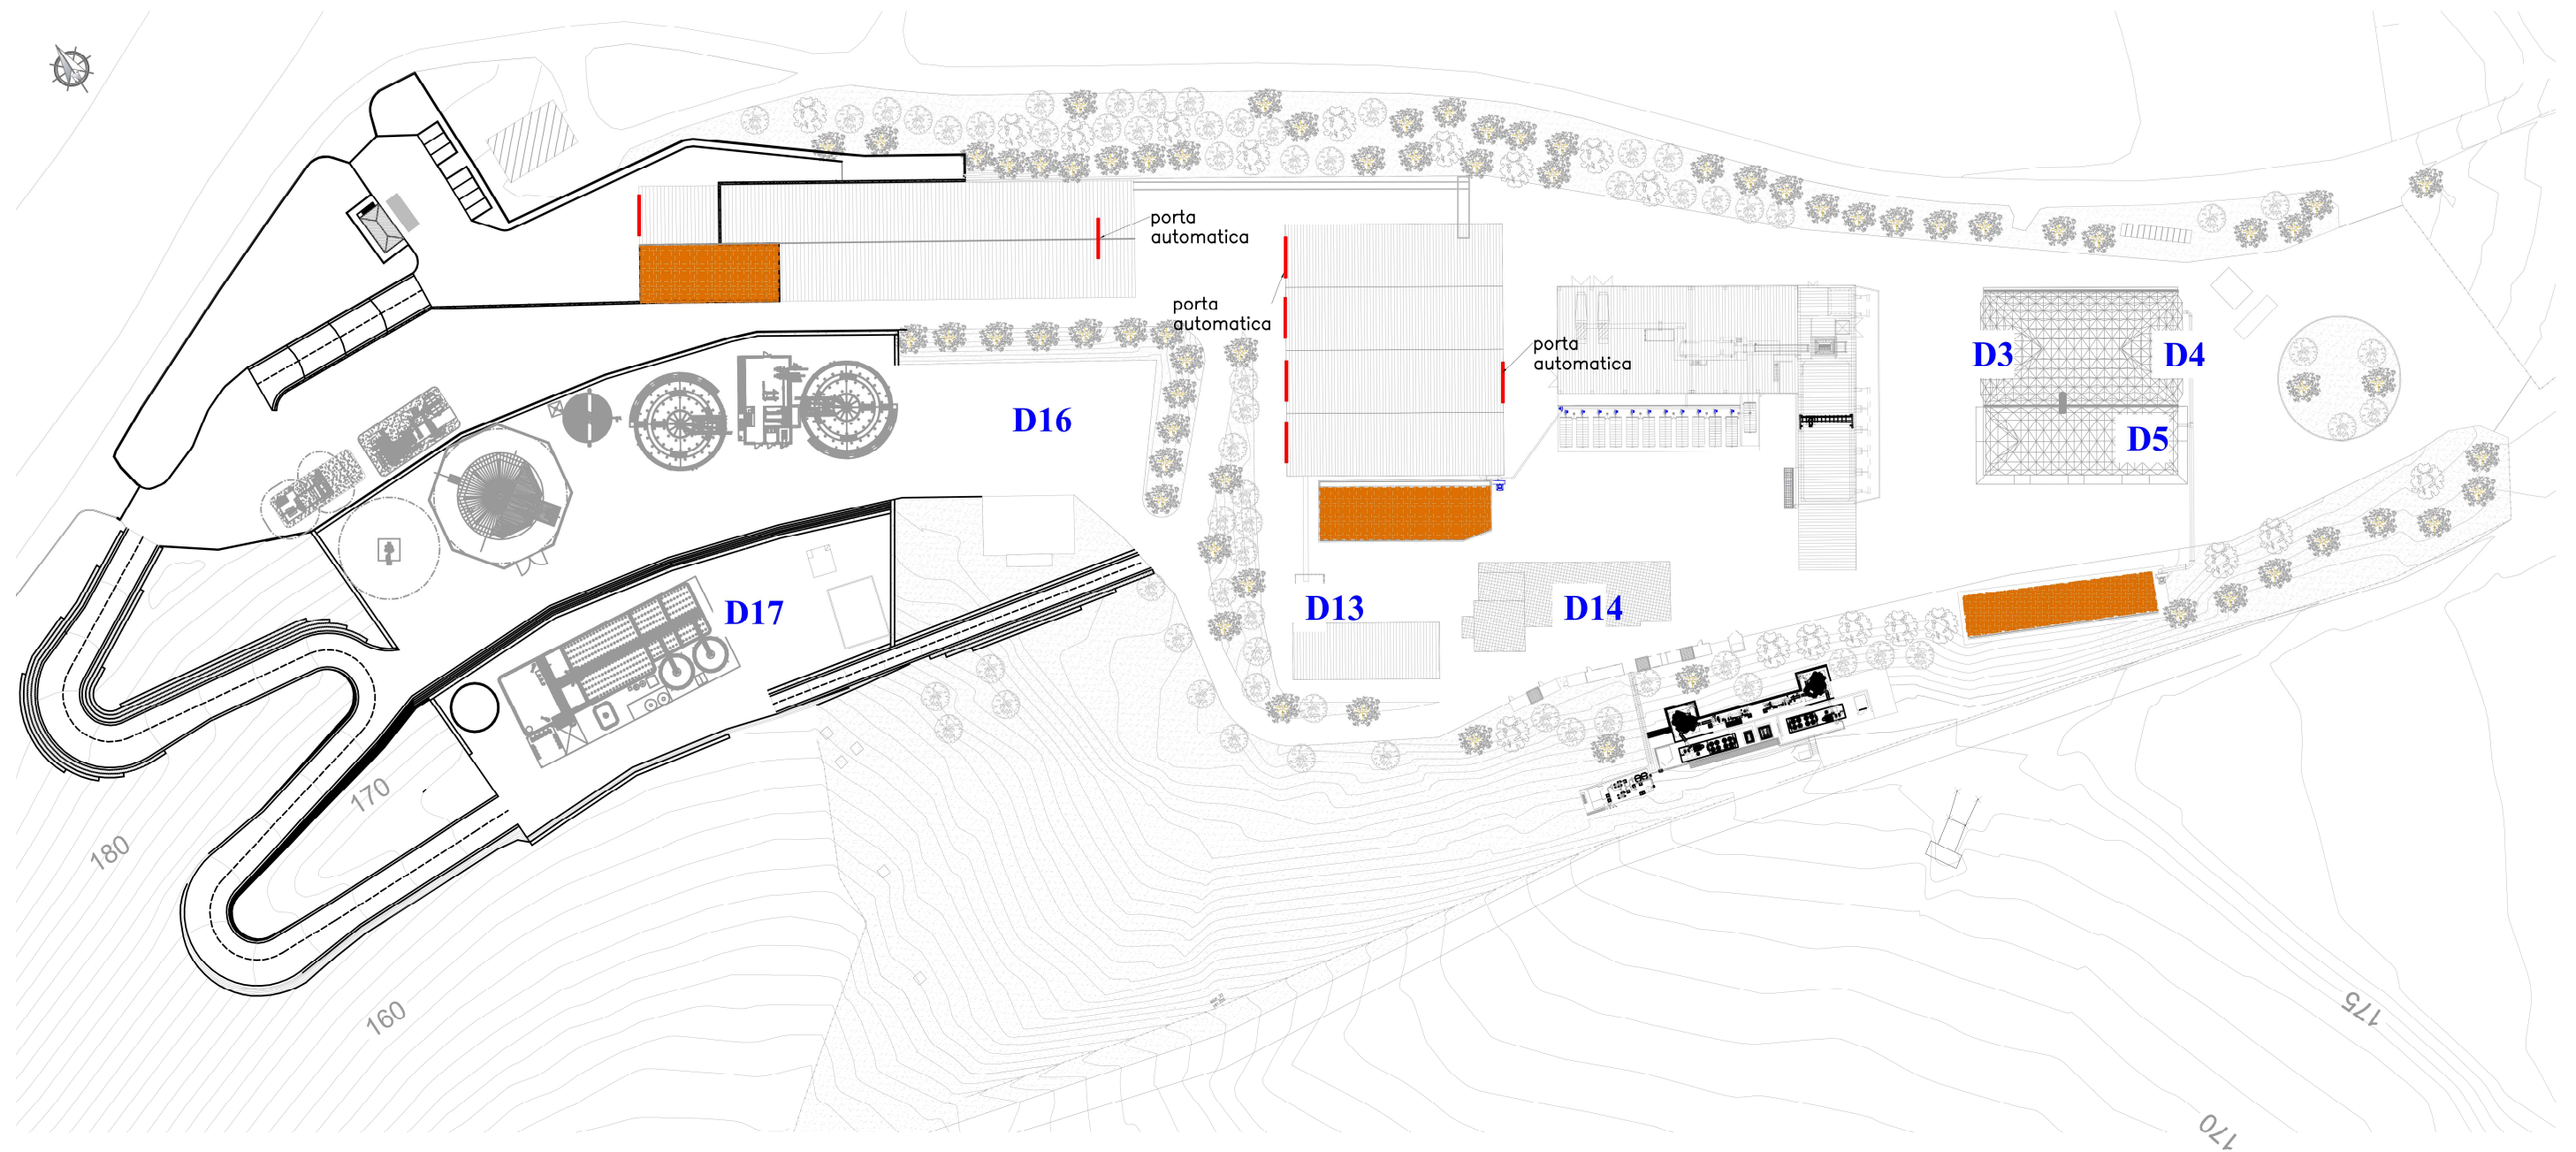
Planimetria con individuazione emissioni diffuse stato modificato
